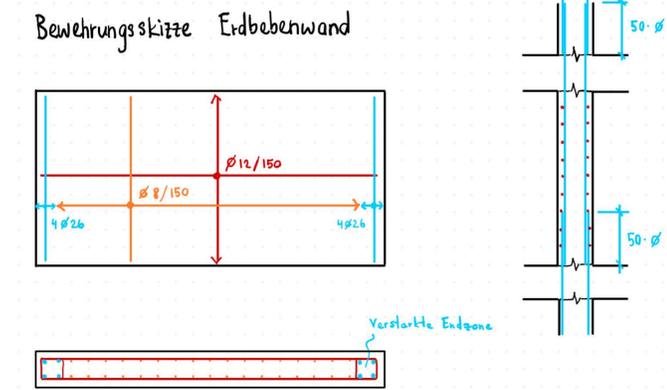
Bewehrungsskizze Erdbebenwand EG
